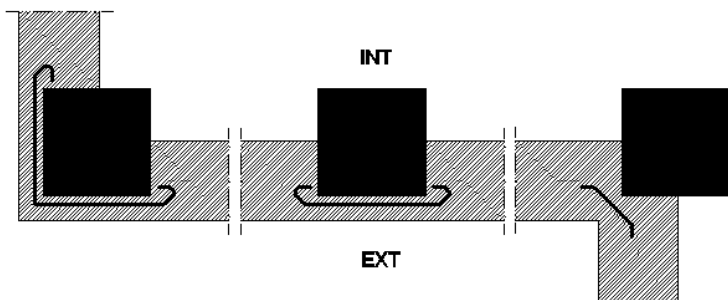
Ejemplo de encuentro de la fachada con los pilares
